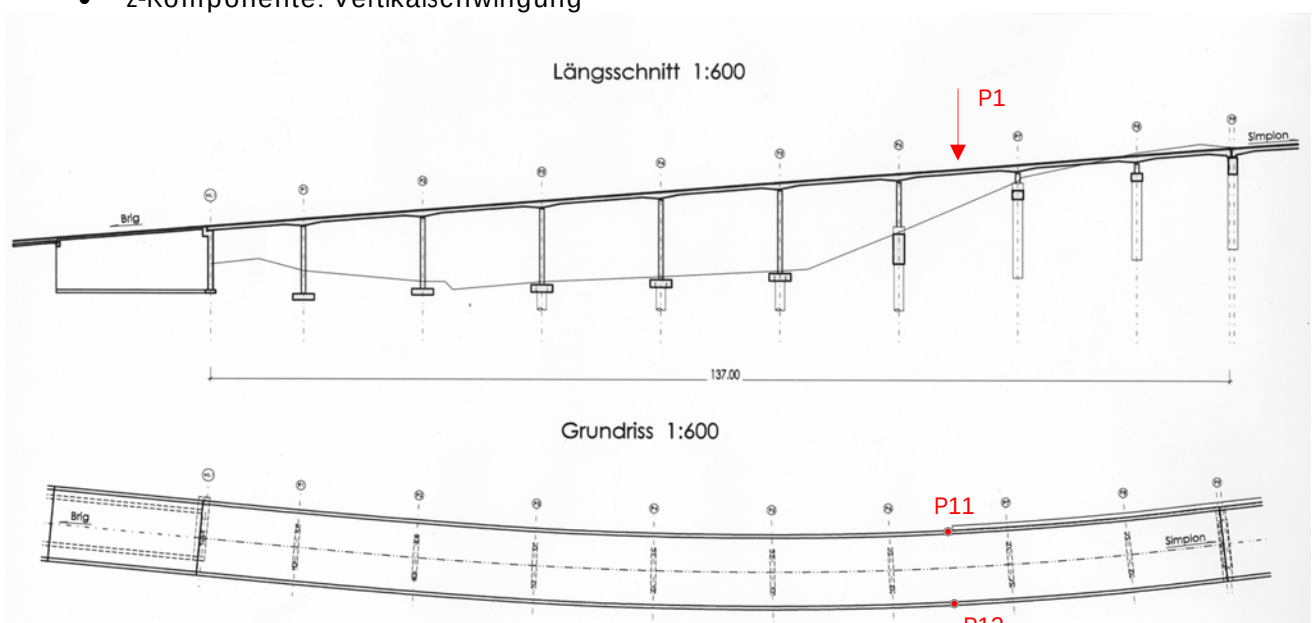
Brunnenbrücke I, Messpunkte P1
